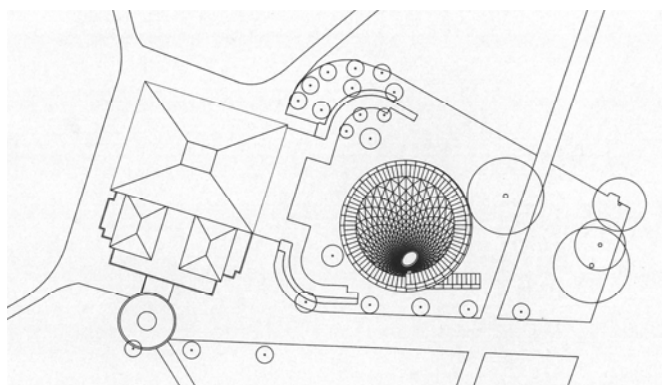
Planta de implantação, pavilhão de Olafur Eliasson e Kjetil Thorsen, 2007.
